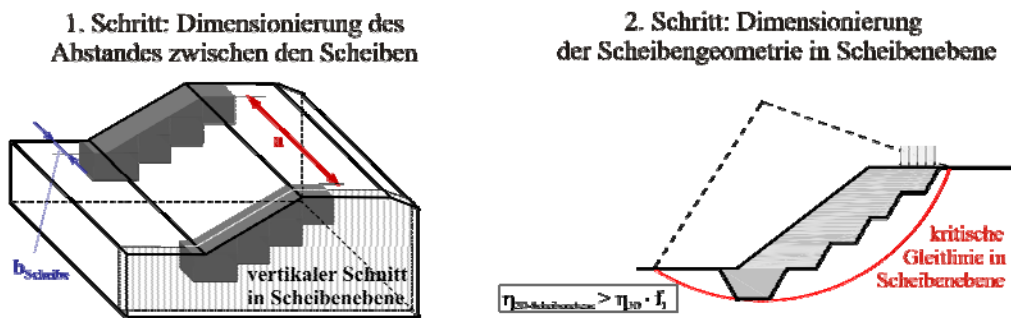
Fall A1 – Prinzip der Dimensionierung der Scheibenabmessungen
